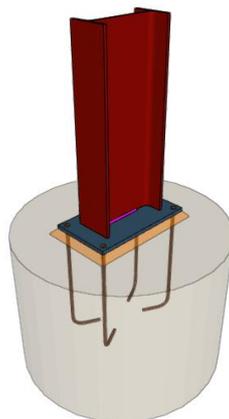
Vista unión pilar-cimentación pilares hastiales
